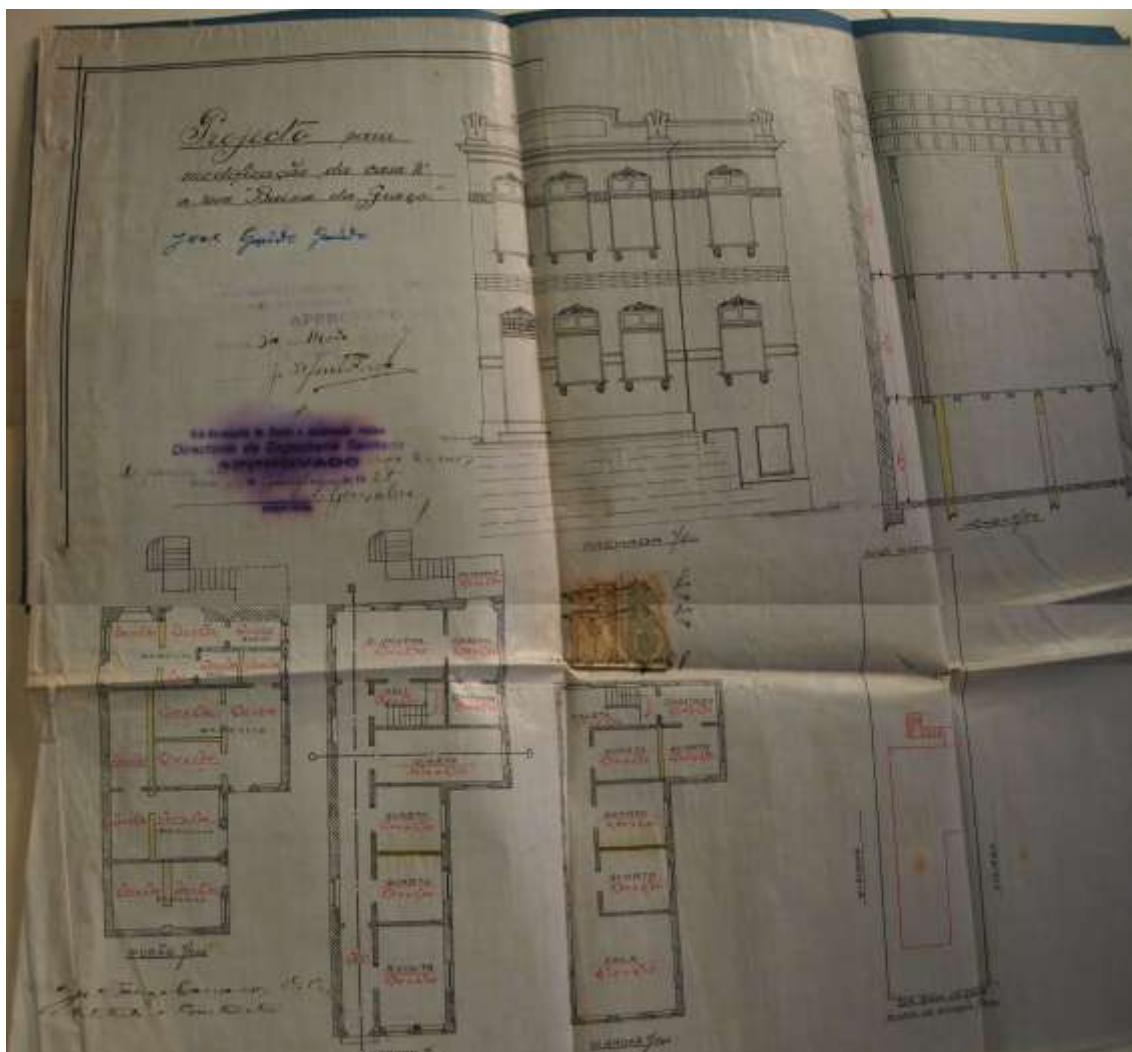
Conjunto posterior a Lei 1146/1926, mostra planta de situação. Projeto para o distrito da Vitória apresentado em 1927. À esquerda a planta de situação no lado direito inferior. Abaixo prancha com corte longitudinal e perfil do terreno. Fotografias de peças gráficas em papel do arquivo da Fundação Gregório de Matos, 2011.
